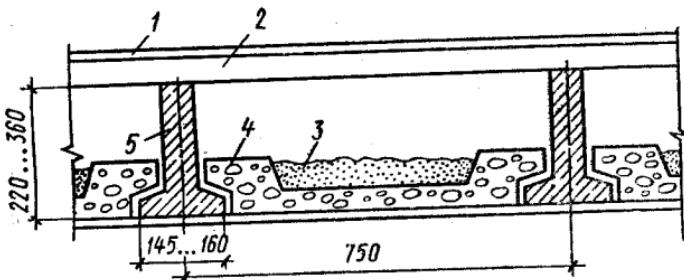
Конструкции для замены перекрытий с железобетонными прогонами таврового сечения:
